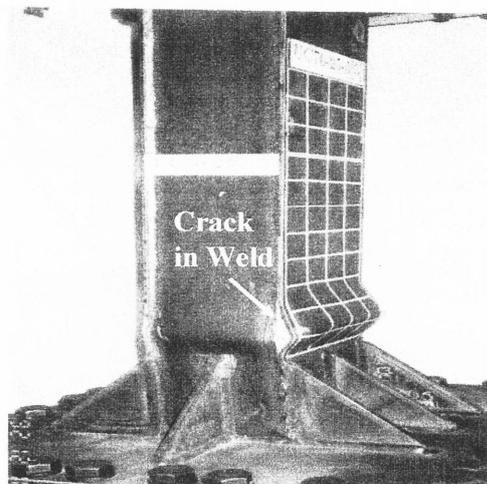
橋脚角溶接部の割れ (実験)
